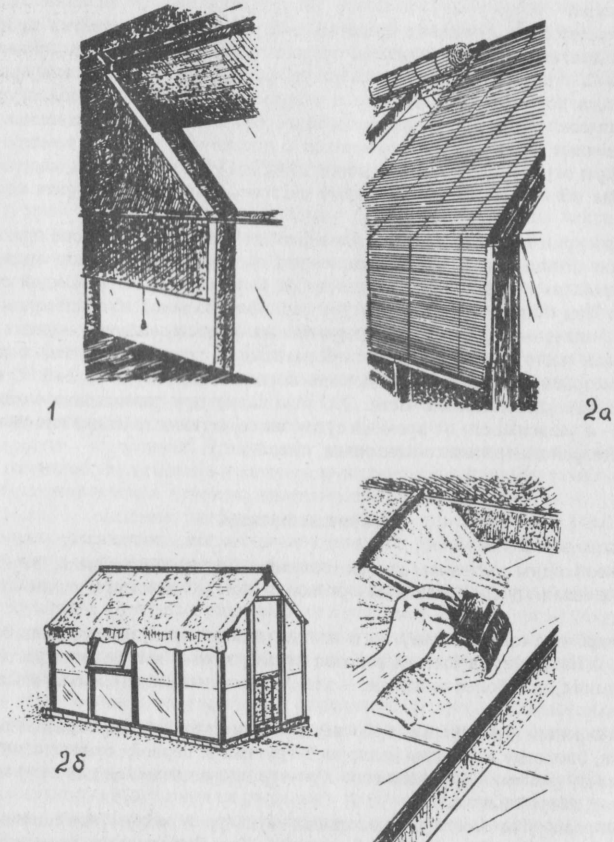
Оборудование теплиц, застекленных веранд и балконов, окон для отражения избытка световой энергии: 1 — внутренний светоотражающий экран из непрозрачной ткани, дымчатой пленки или фольги; 2 — наружные цинковки (а) и брезент (б); 3 — побелка мелом
